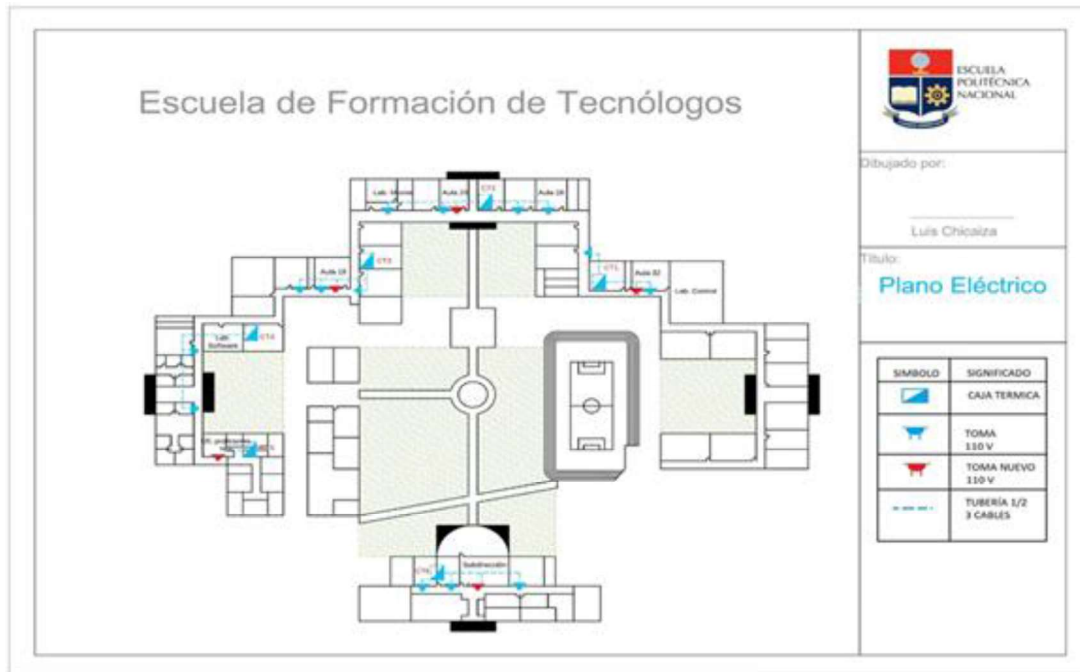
Plano eléctrico de las instalaciones de la ESFOT
